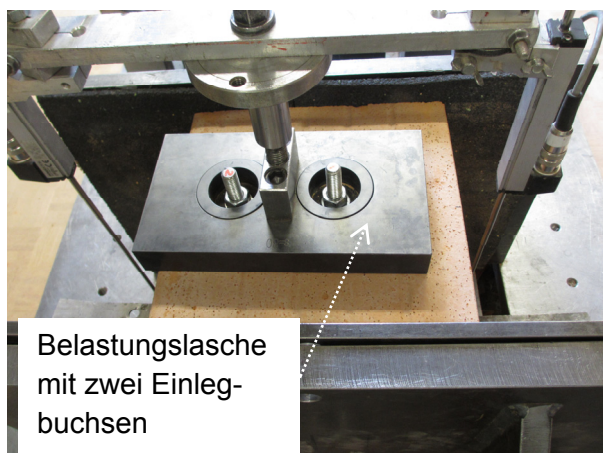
Detail der Versuchseinrichtung (Zugversuche mit Doppelbefestigung)
